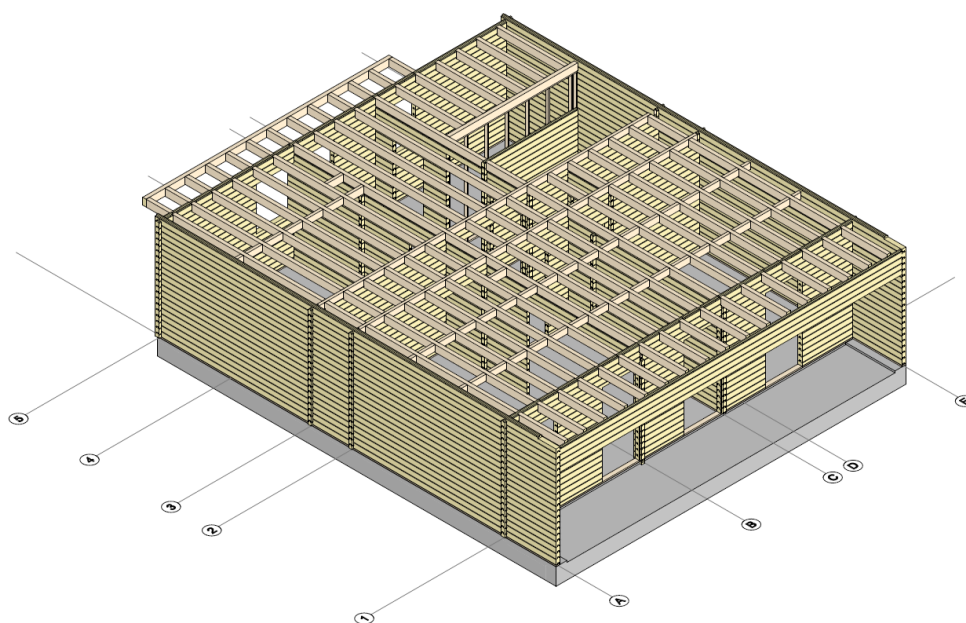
Axonometria da estrutura das paredes do piso térreo e do pavimento do piso 1.
